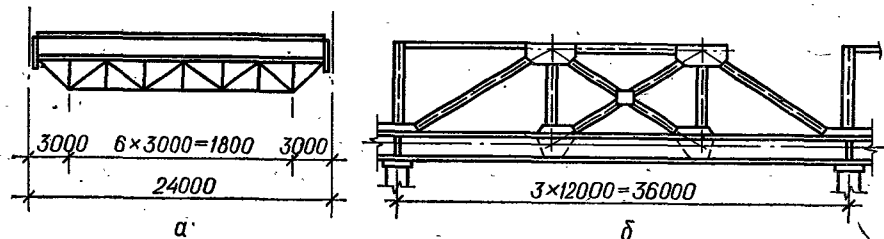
Подкрановая (а) и подкраново-подстропильная (б) фермы.
